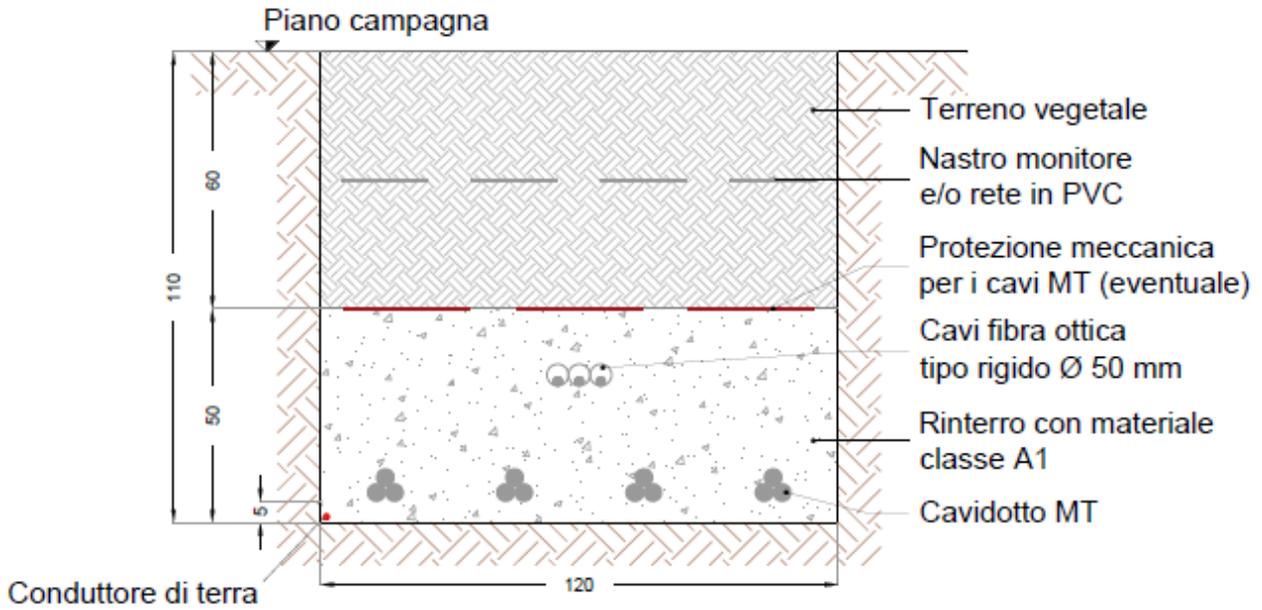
Sezione tipo cavidotto MT quattro terne su strada terreno
